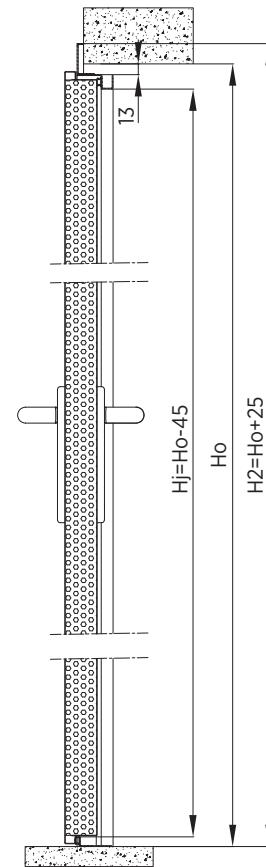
Montaggio porta UTILITY con telaio angolare - sezione verticale.
